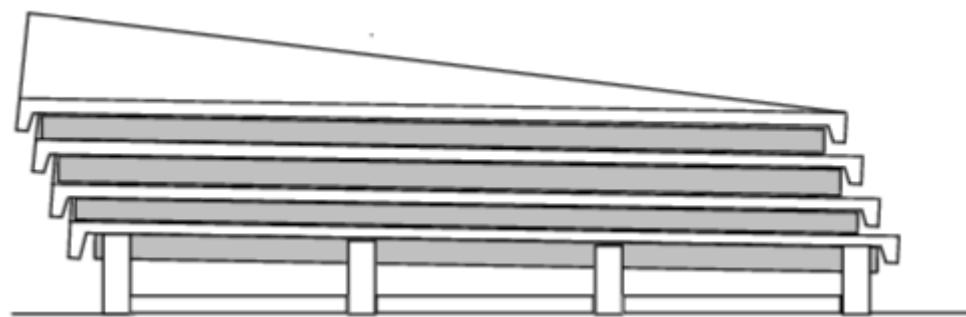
Corte longitudinal esquemático do empilhamento das peças
